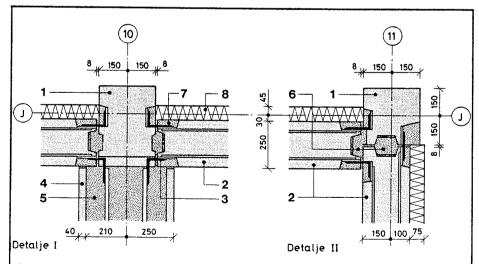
Kældervægssamlinger, detalje I og II, vandrette snit 1:20. 1 Søjleelementer, 2 Vægelementer, 3 påsvejste L-stål, I = 160, 4 Filigranplader, 5 in situ beton, 6 plastisk fugebeton, 7 cementmørtel, 8 opklæbet mineraluld.
